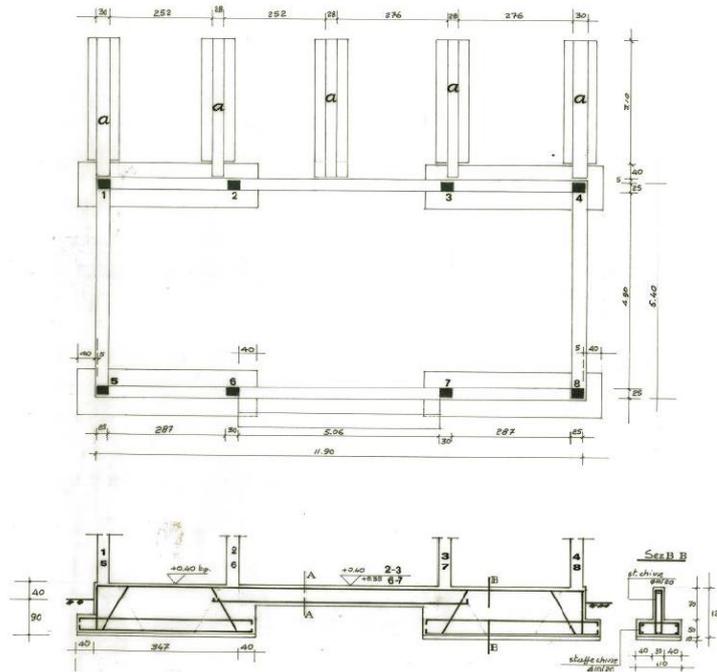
Cabina Elettrica 12 – Documentazione di progetto (Fondazioni – Pianta e Sezioni)
